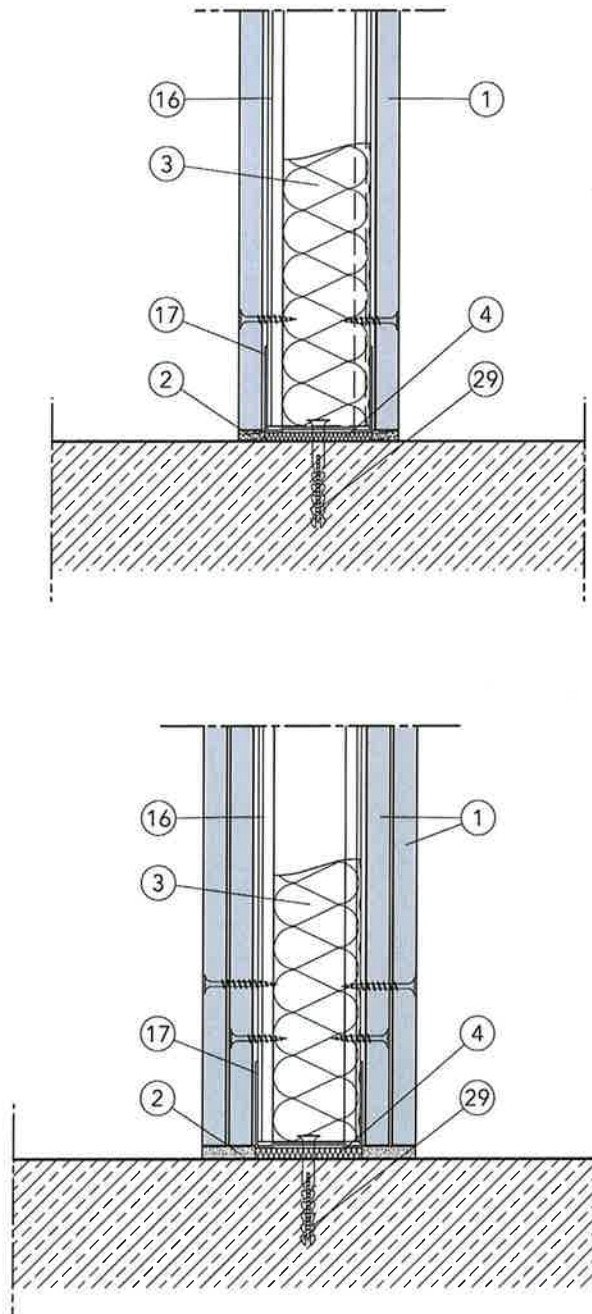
Starrer Bodenanschluss an Massivdecke mit einlagiger und zweilagiger Bekleidung
